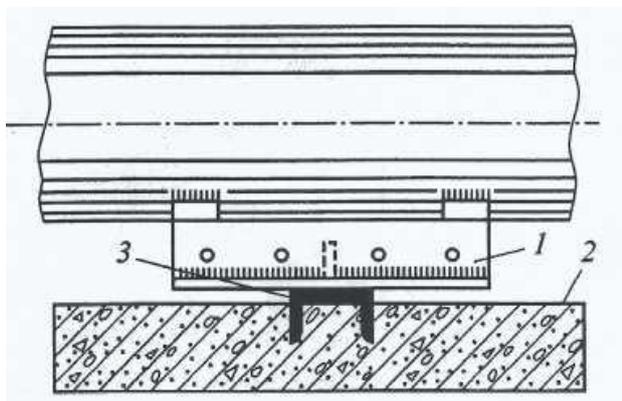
Скользящая опора: 1 – сварная конструкция скользящей опоры; 2 – опорная бетонная плита; 3 – закладная деталь (стальной швеллер)
